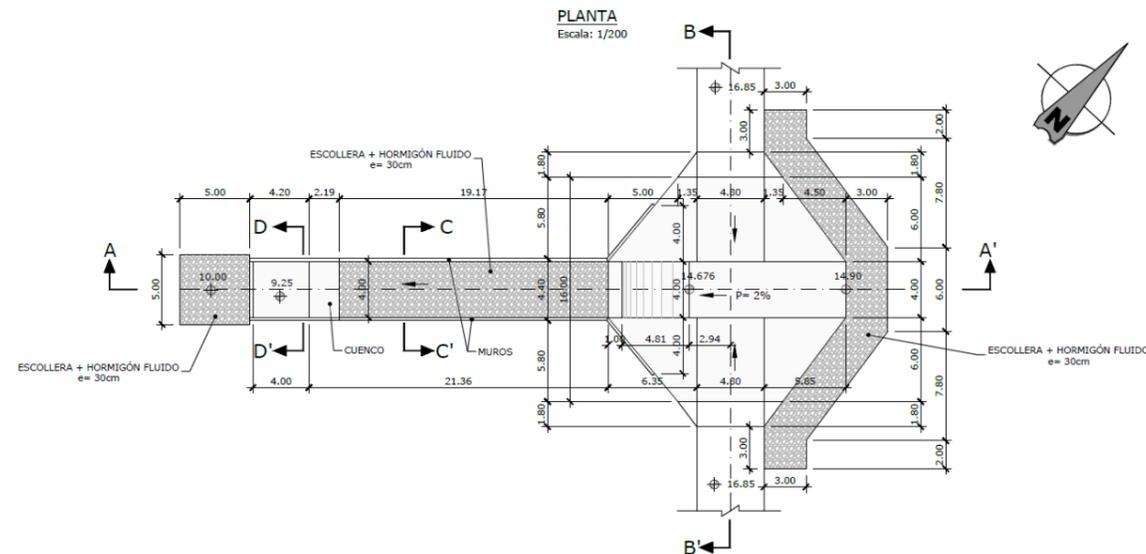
Canal de interconexión entre balsas. S. Alcantarillas
